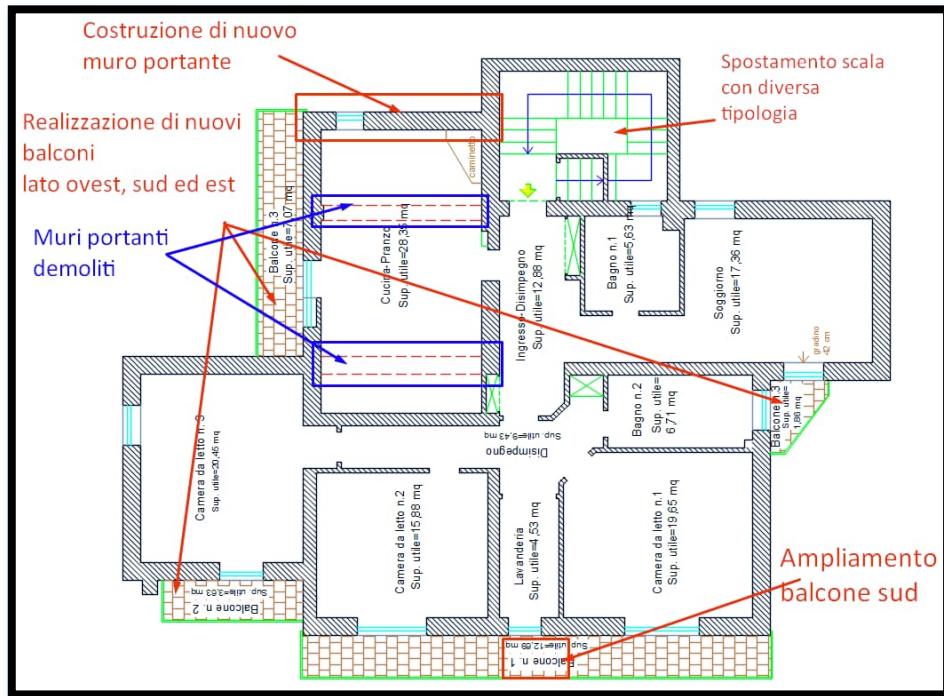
Rilievo appartamento – Rappresentazione difformità strutturali
